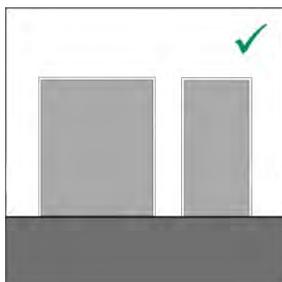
Schaufensterunterkante bis zum Gebäudeabschluss
